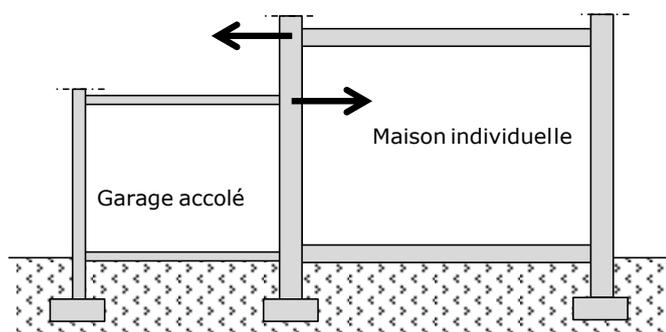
exemple de sollicitations supplémentaires sur la maison individuelle accolée à un garage
